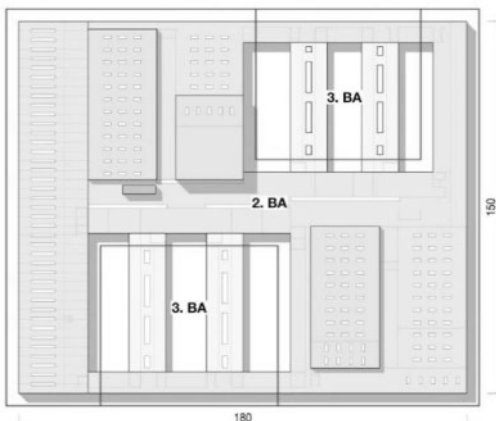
Grundriss mit Bauabschnitten
